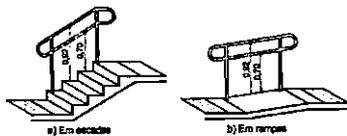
Altura dos corrimãos em rampas e escadas - Exemplos
